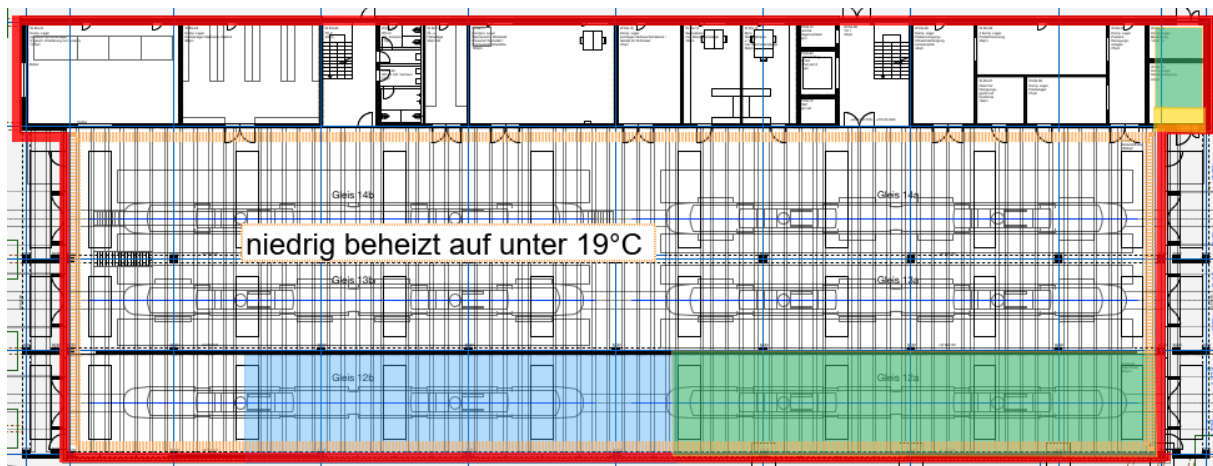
Grundriss thermische Hülle EG, Wasch-/Wartungshalle
